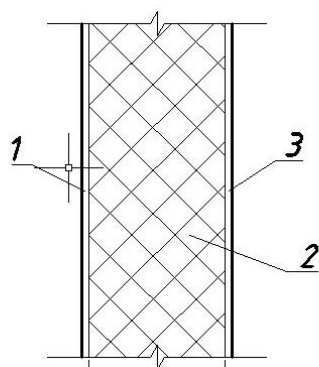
Конструкция наружной стены цеховой части здания
